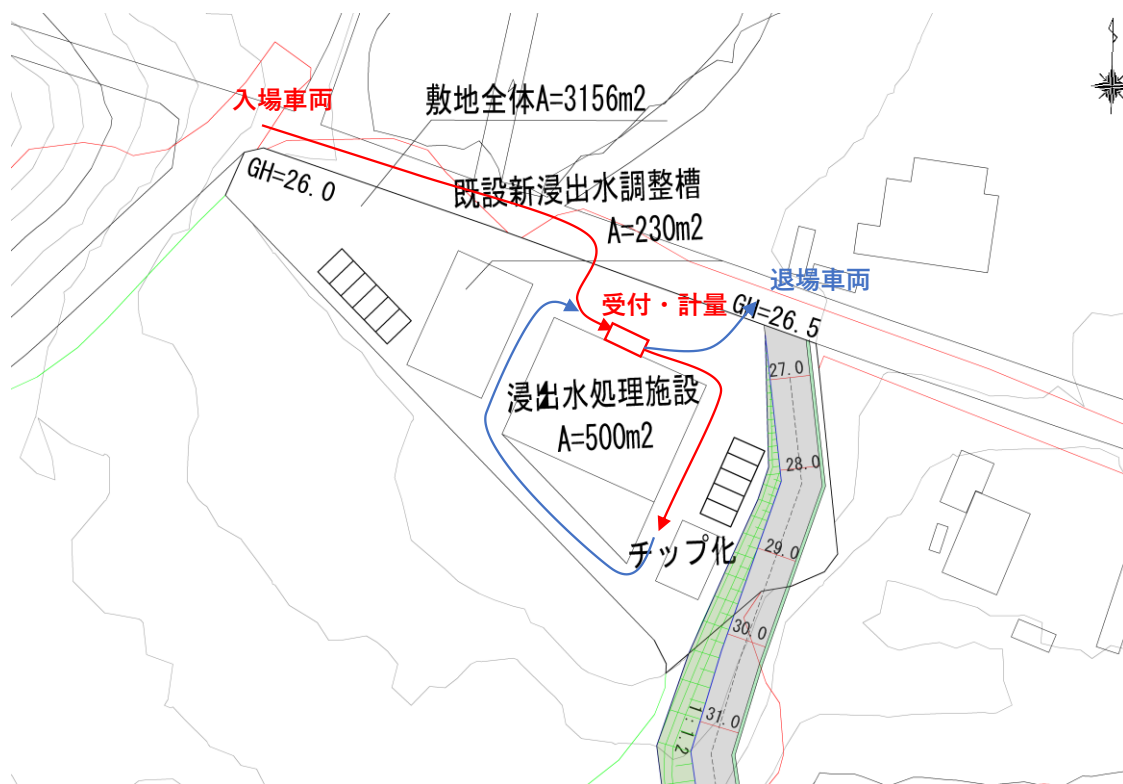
管理棟・浸出水処理施設用地の外構計画平面図
